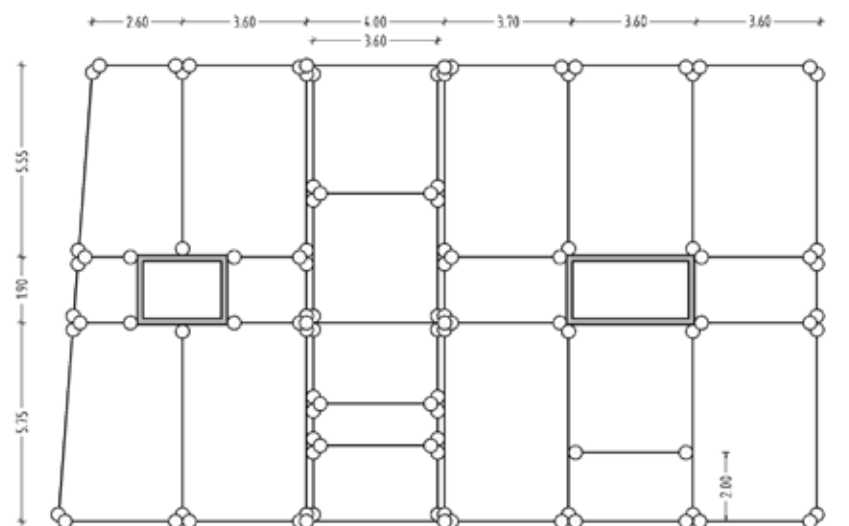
Grundriss Kern II [m]
